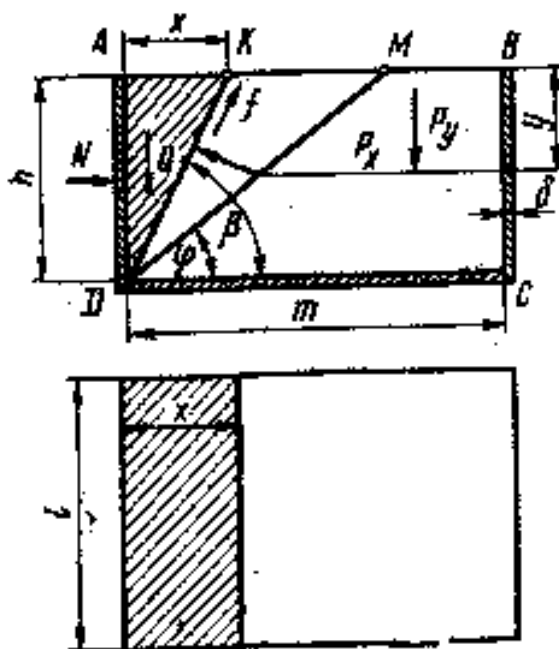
Схема расположения сил, действующих на стенки корпуса бункера
